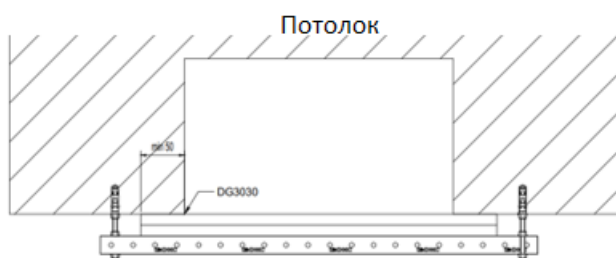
Крепление короба с одной стенкой к несущей поверхности горизонтально
